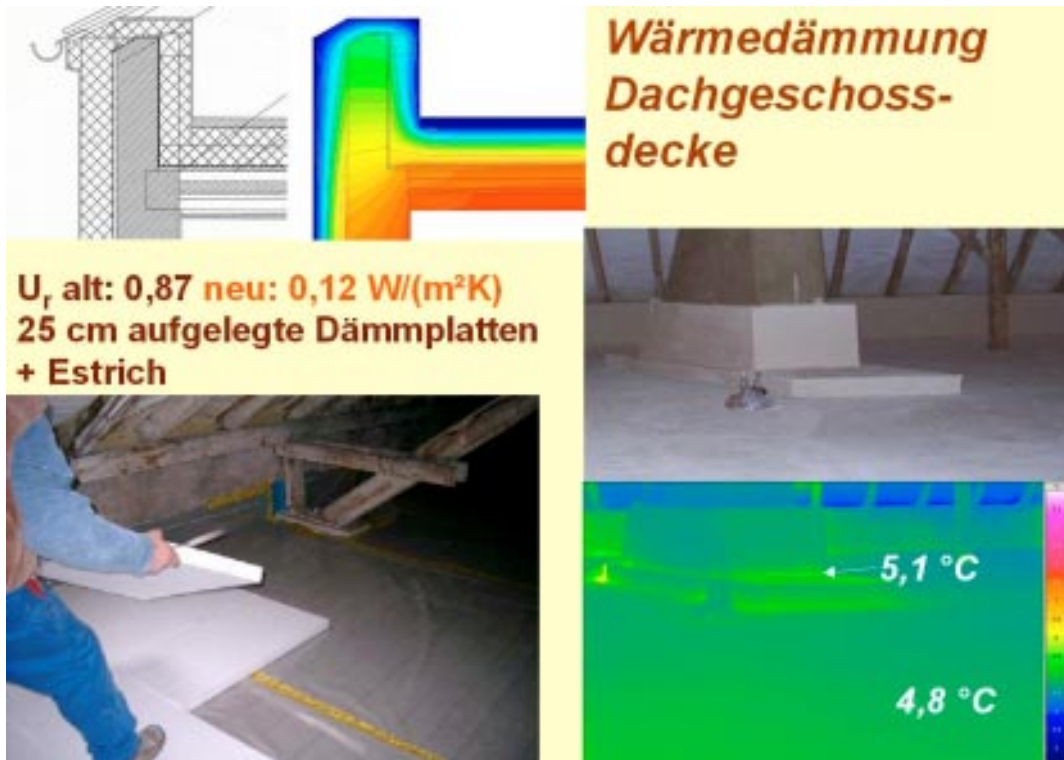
Planzeichnung, Isothermenberechnung, Ausführungsfoto und thermografische Aufnahme nach Fertigstellung der Wärmedämmung der obersten Geschossdecke (inkl. Detail am Kniestock)
